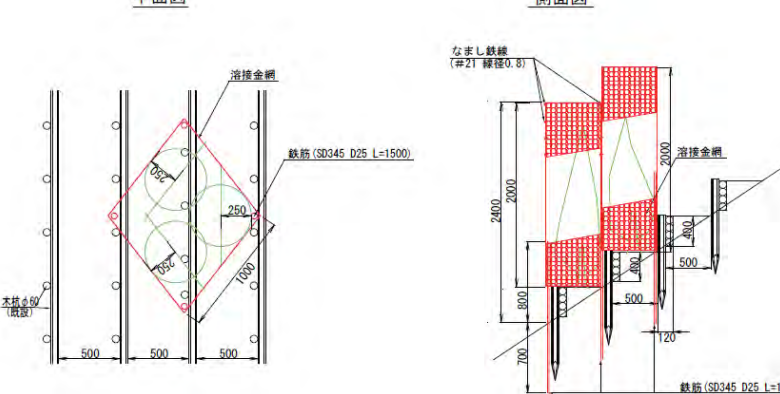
緑化対策試験施工実施状況及び施工後3年の経緯
